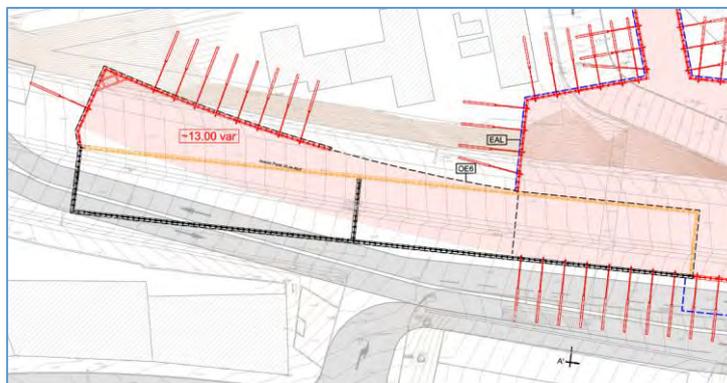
Planta de Dimensionamento Contenção Provisória - 3ª Fase de escavação
